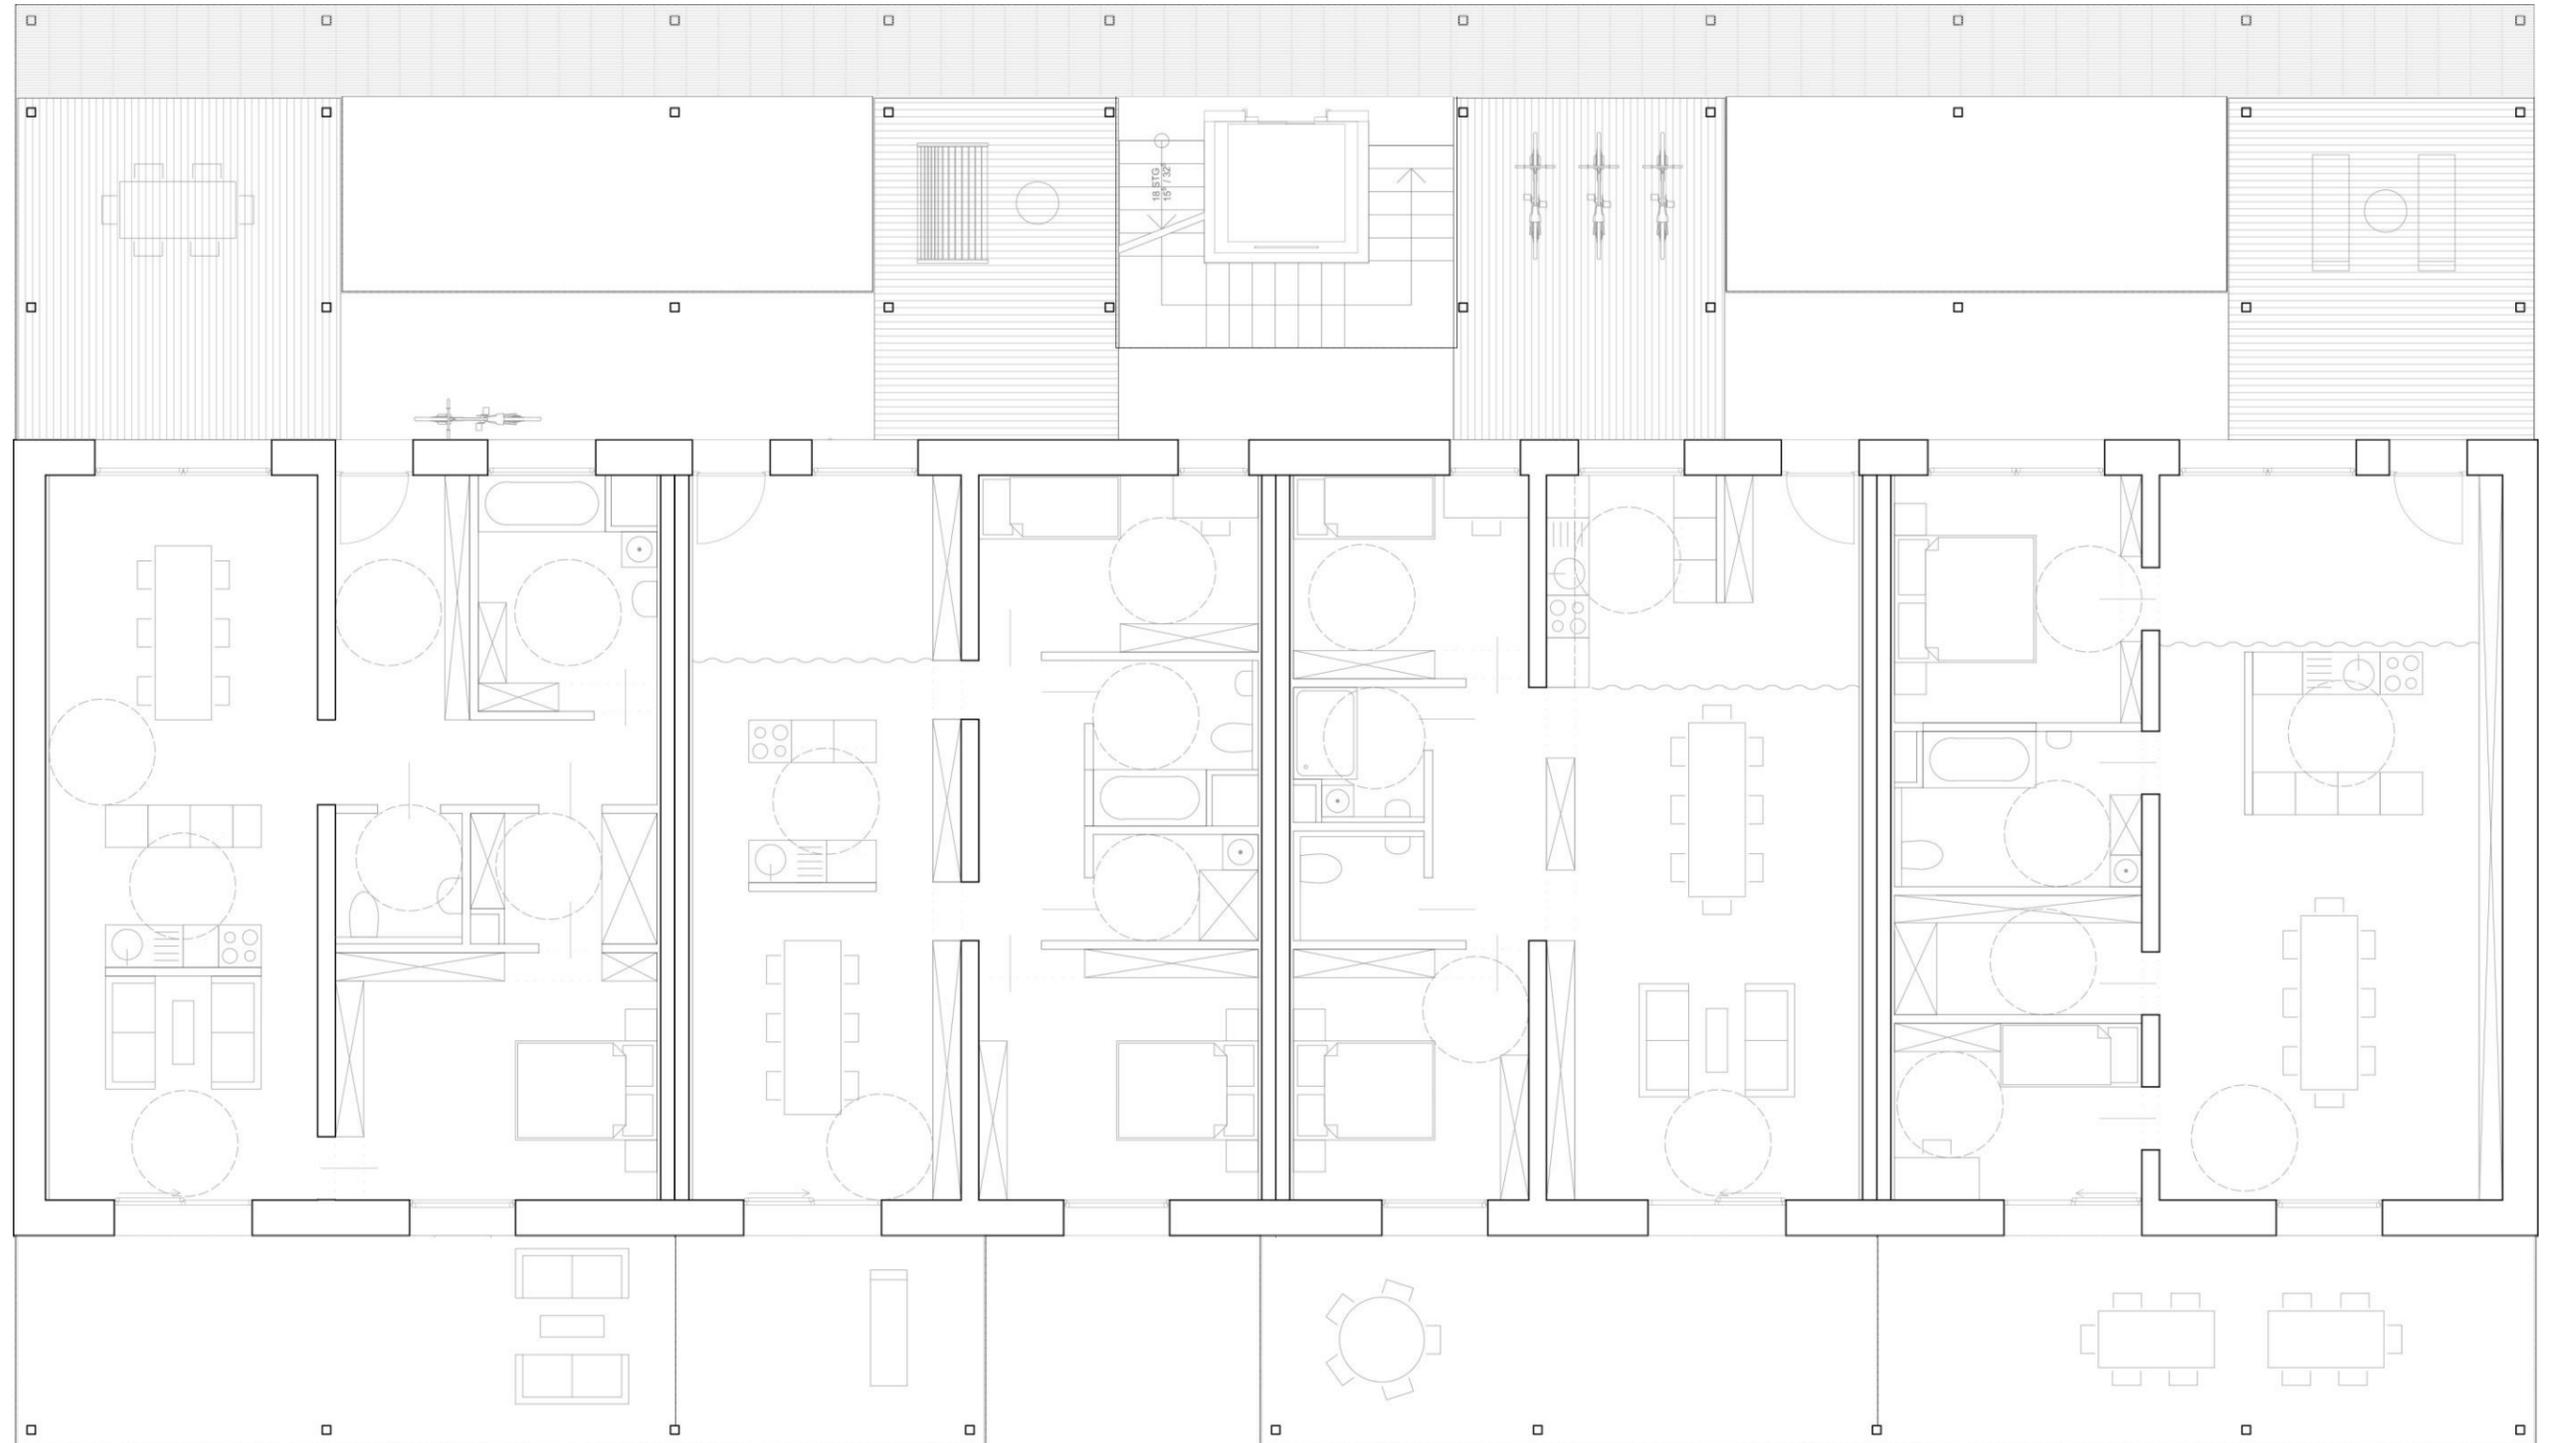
Grundriss 4.Obergeschoss M1:100
